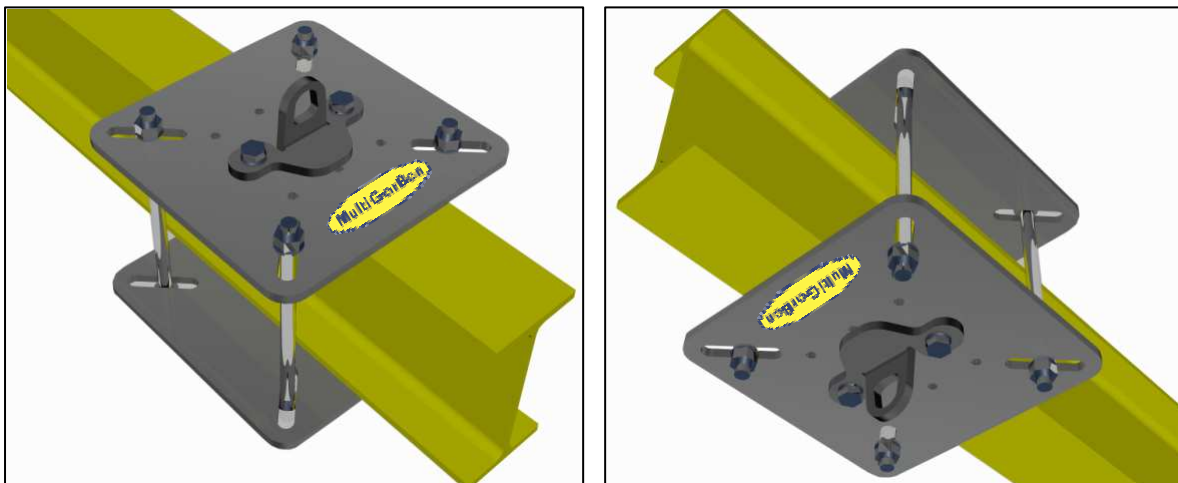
ESTELA CA02, fijado a viga mediante placas por el sistema de abrazadera
